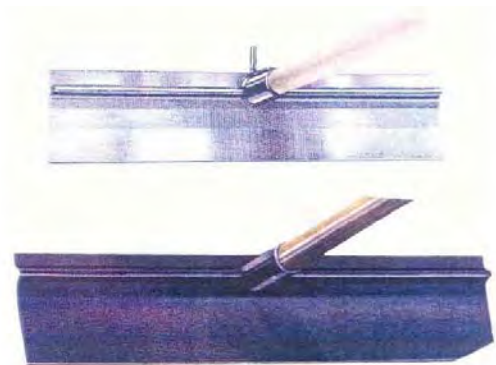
JALADOR PARA CONCRETO EN LOSAS Y FIRMES
